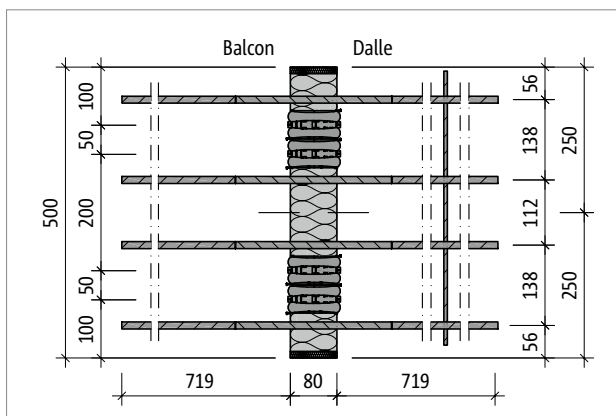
Schöck Isokorb® T type Q-E-V6-L500 : plan de base du produit
